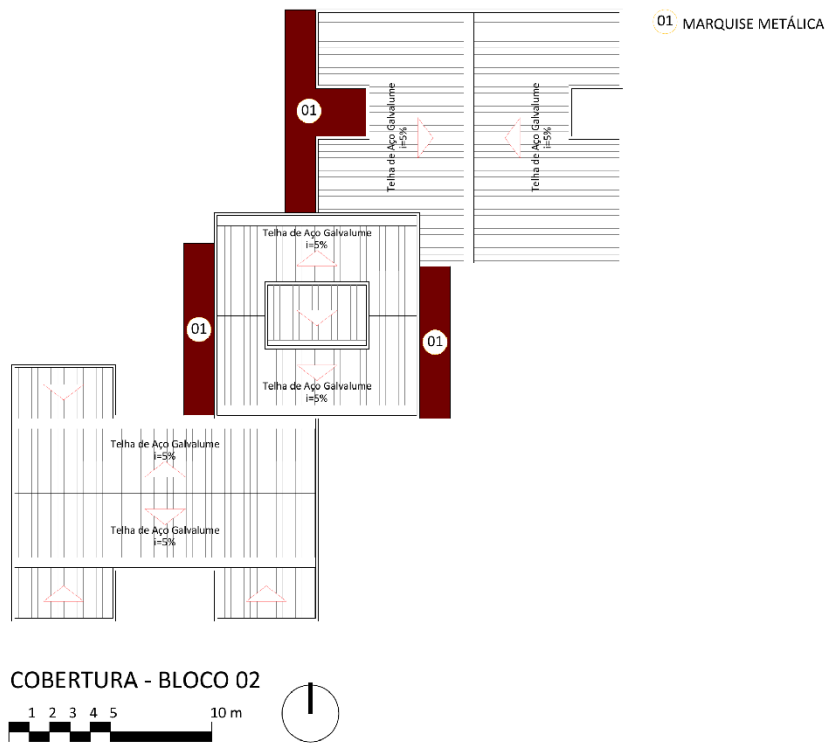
PLANTA COBERTURA DO BLOCO 2. FONTE: AUTORAL.
